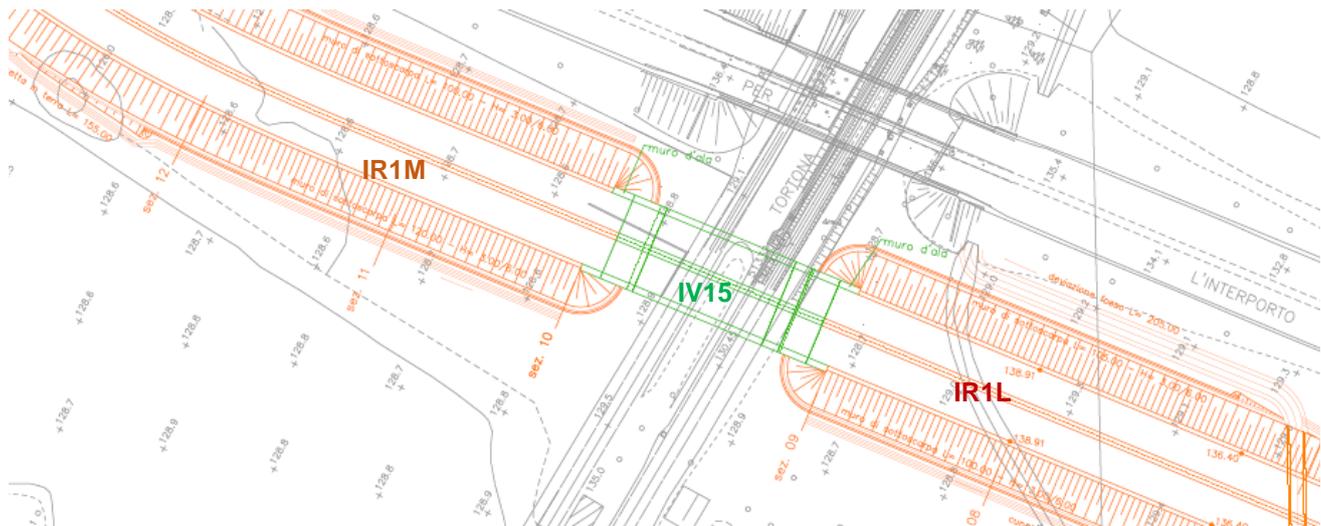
Localizzazione del cavalcaferrovia IV15 nel progetto approvato (in colore verde)
